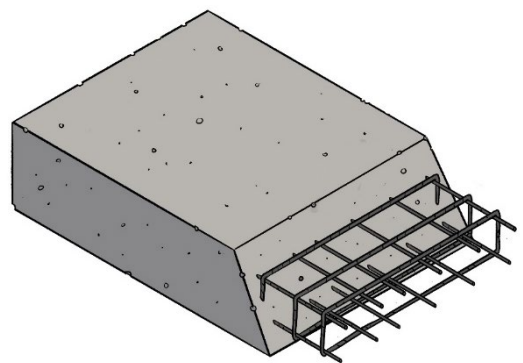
Vergleich Bestandteile Holzmasse mit Betonbau
